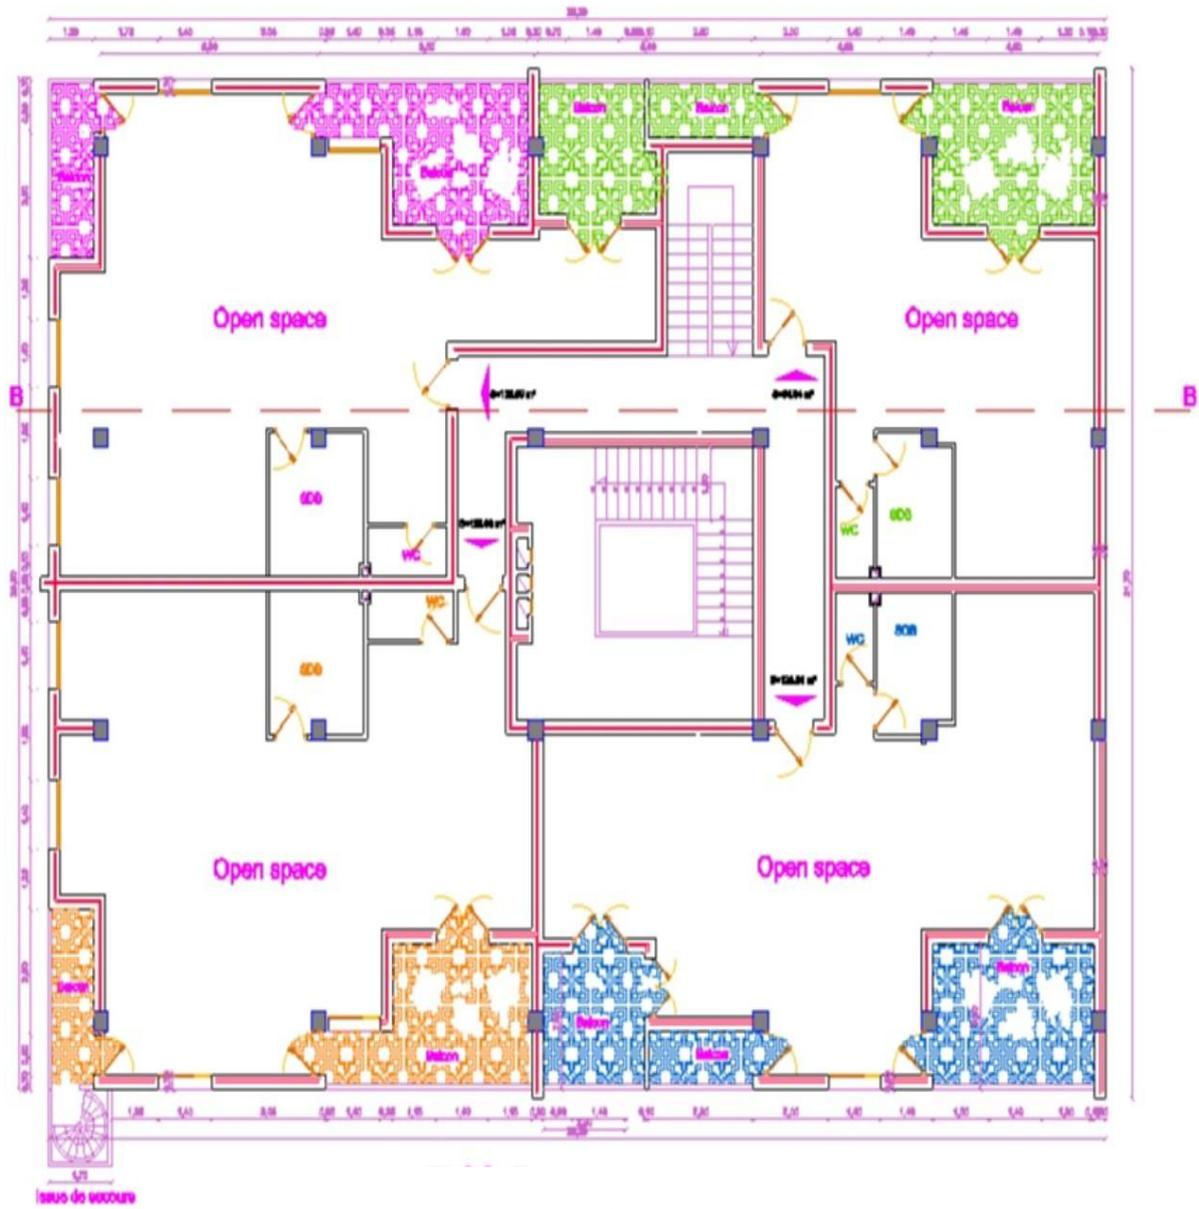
Plan de sol 1^{er} étage bloc B
